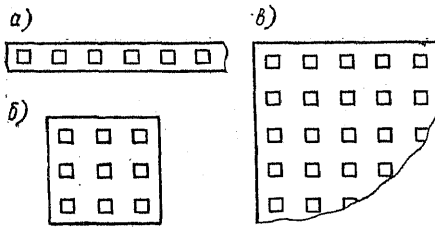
Виды свайных фундаментов в зависимости от размещения свай в плане
